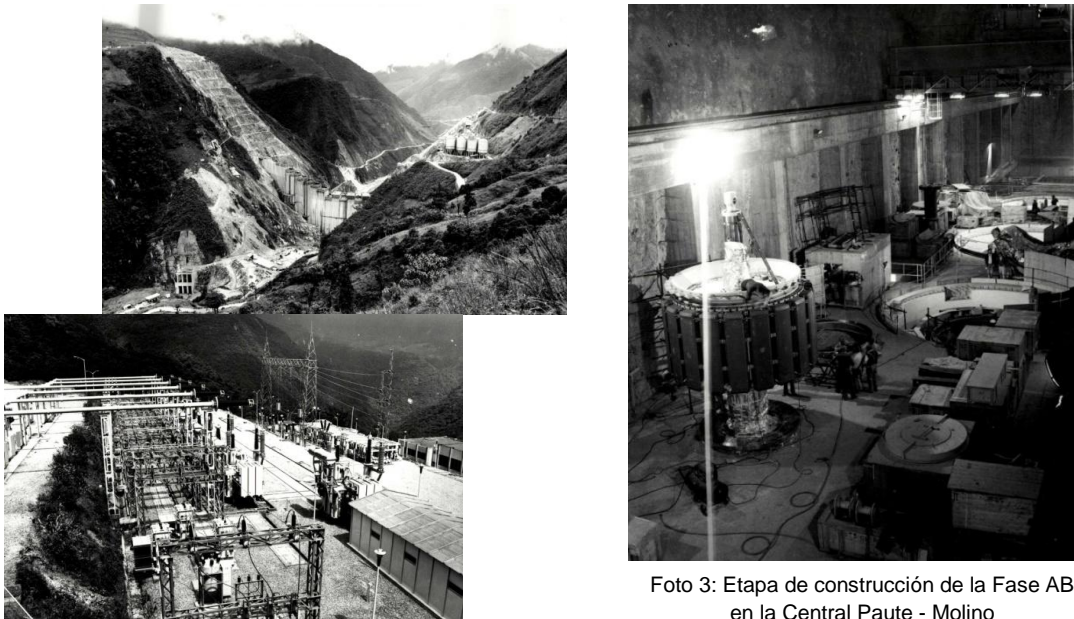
Etapa de construcción de la Fase AB en la Central Paute - Molino
